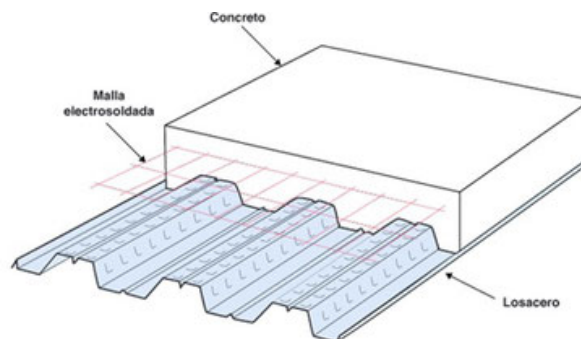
Detalle Constructivo Losacero. Fuente: <https://www.techadosparasucasa.com.mx/> (2018)
